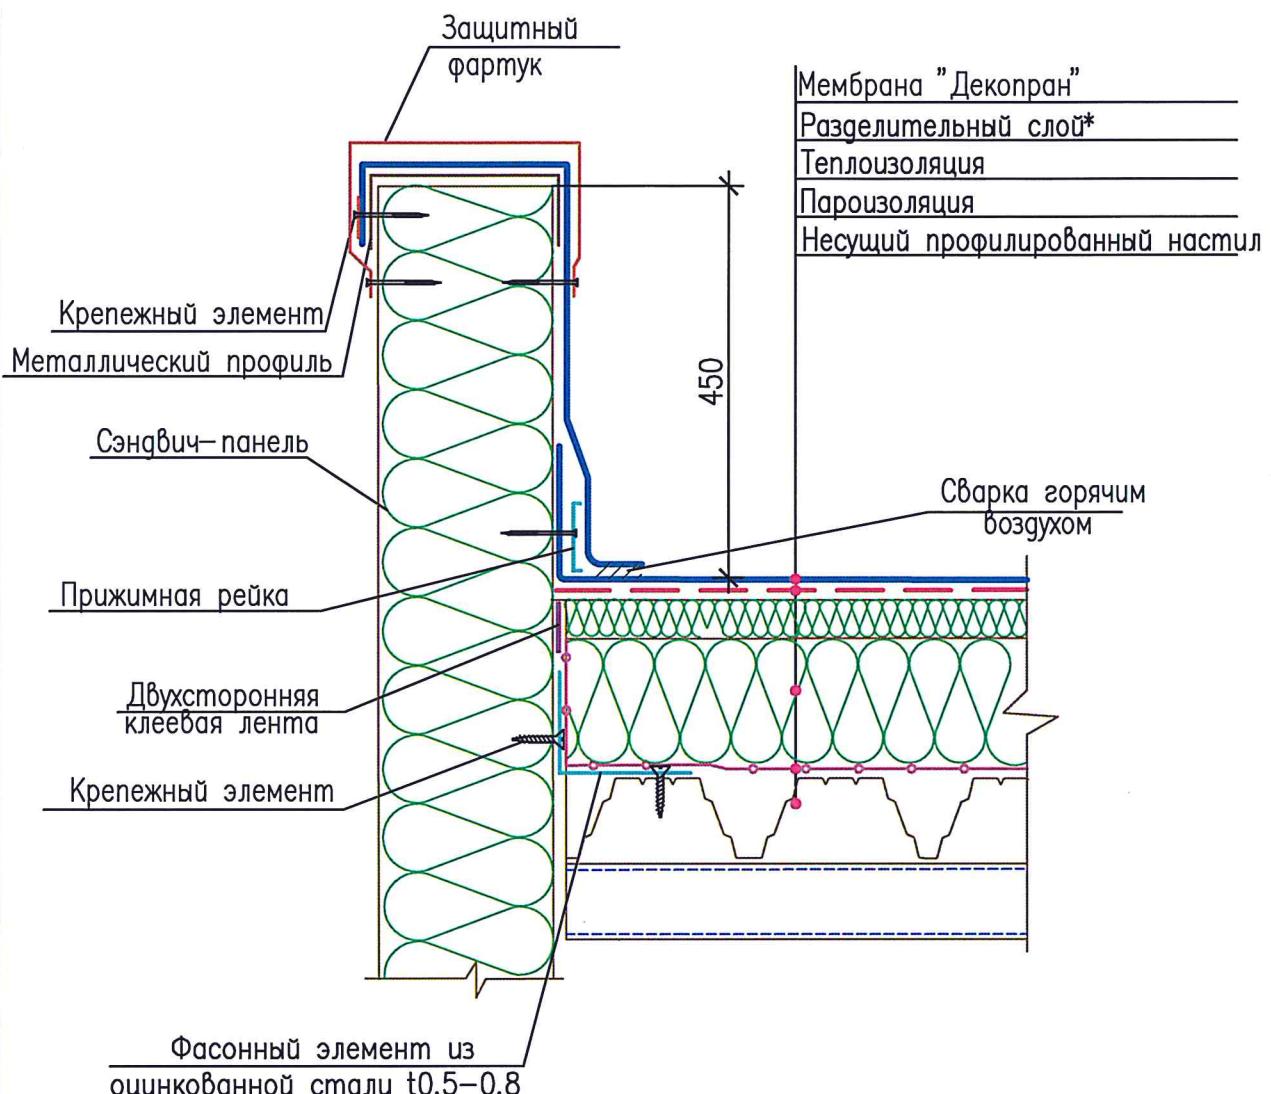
Конструктивное решение узла для кровли с несущим профилированным настилом с механическим закреплением.
